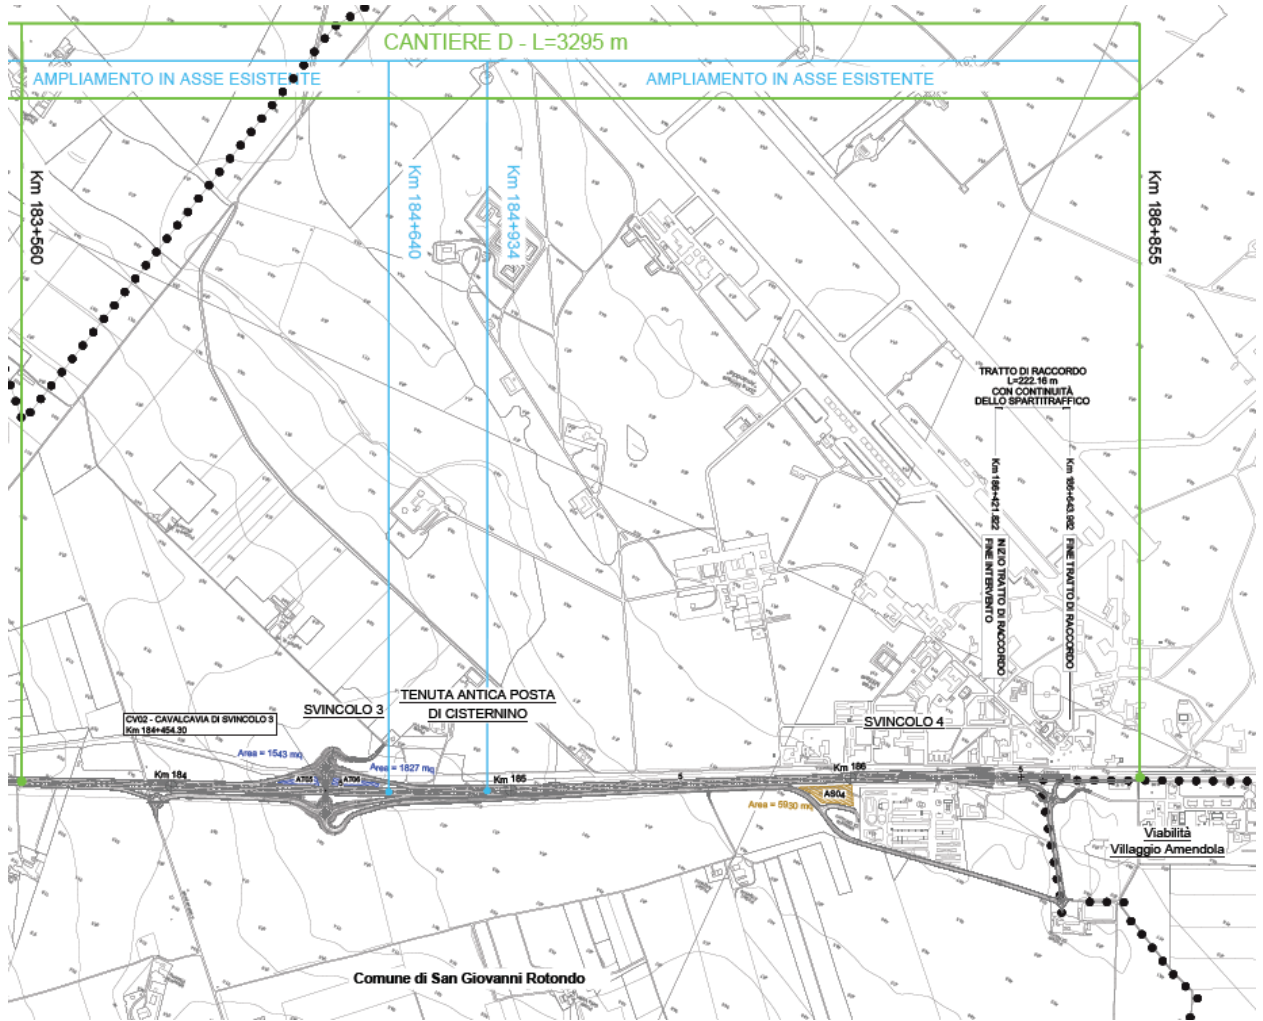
Stralci planimetrici con localizzazione Cantiere D
